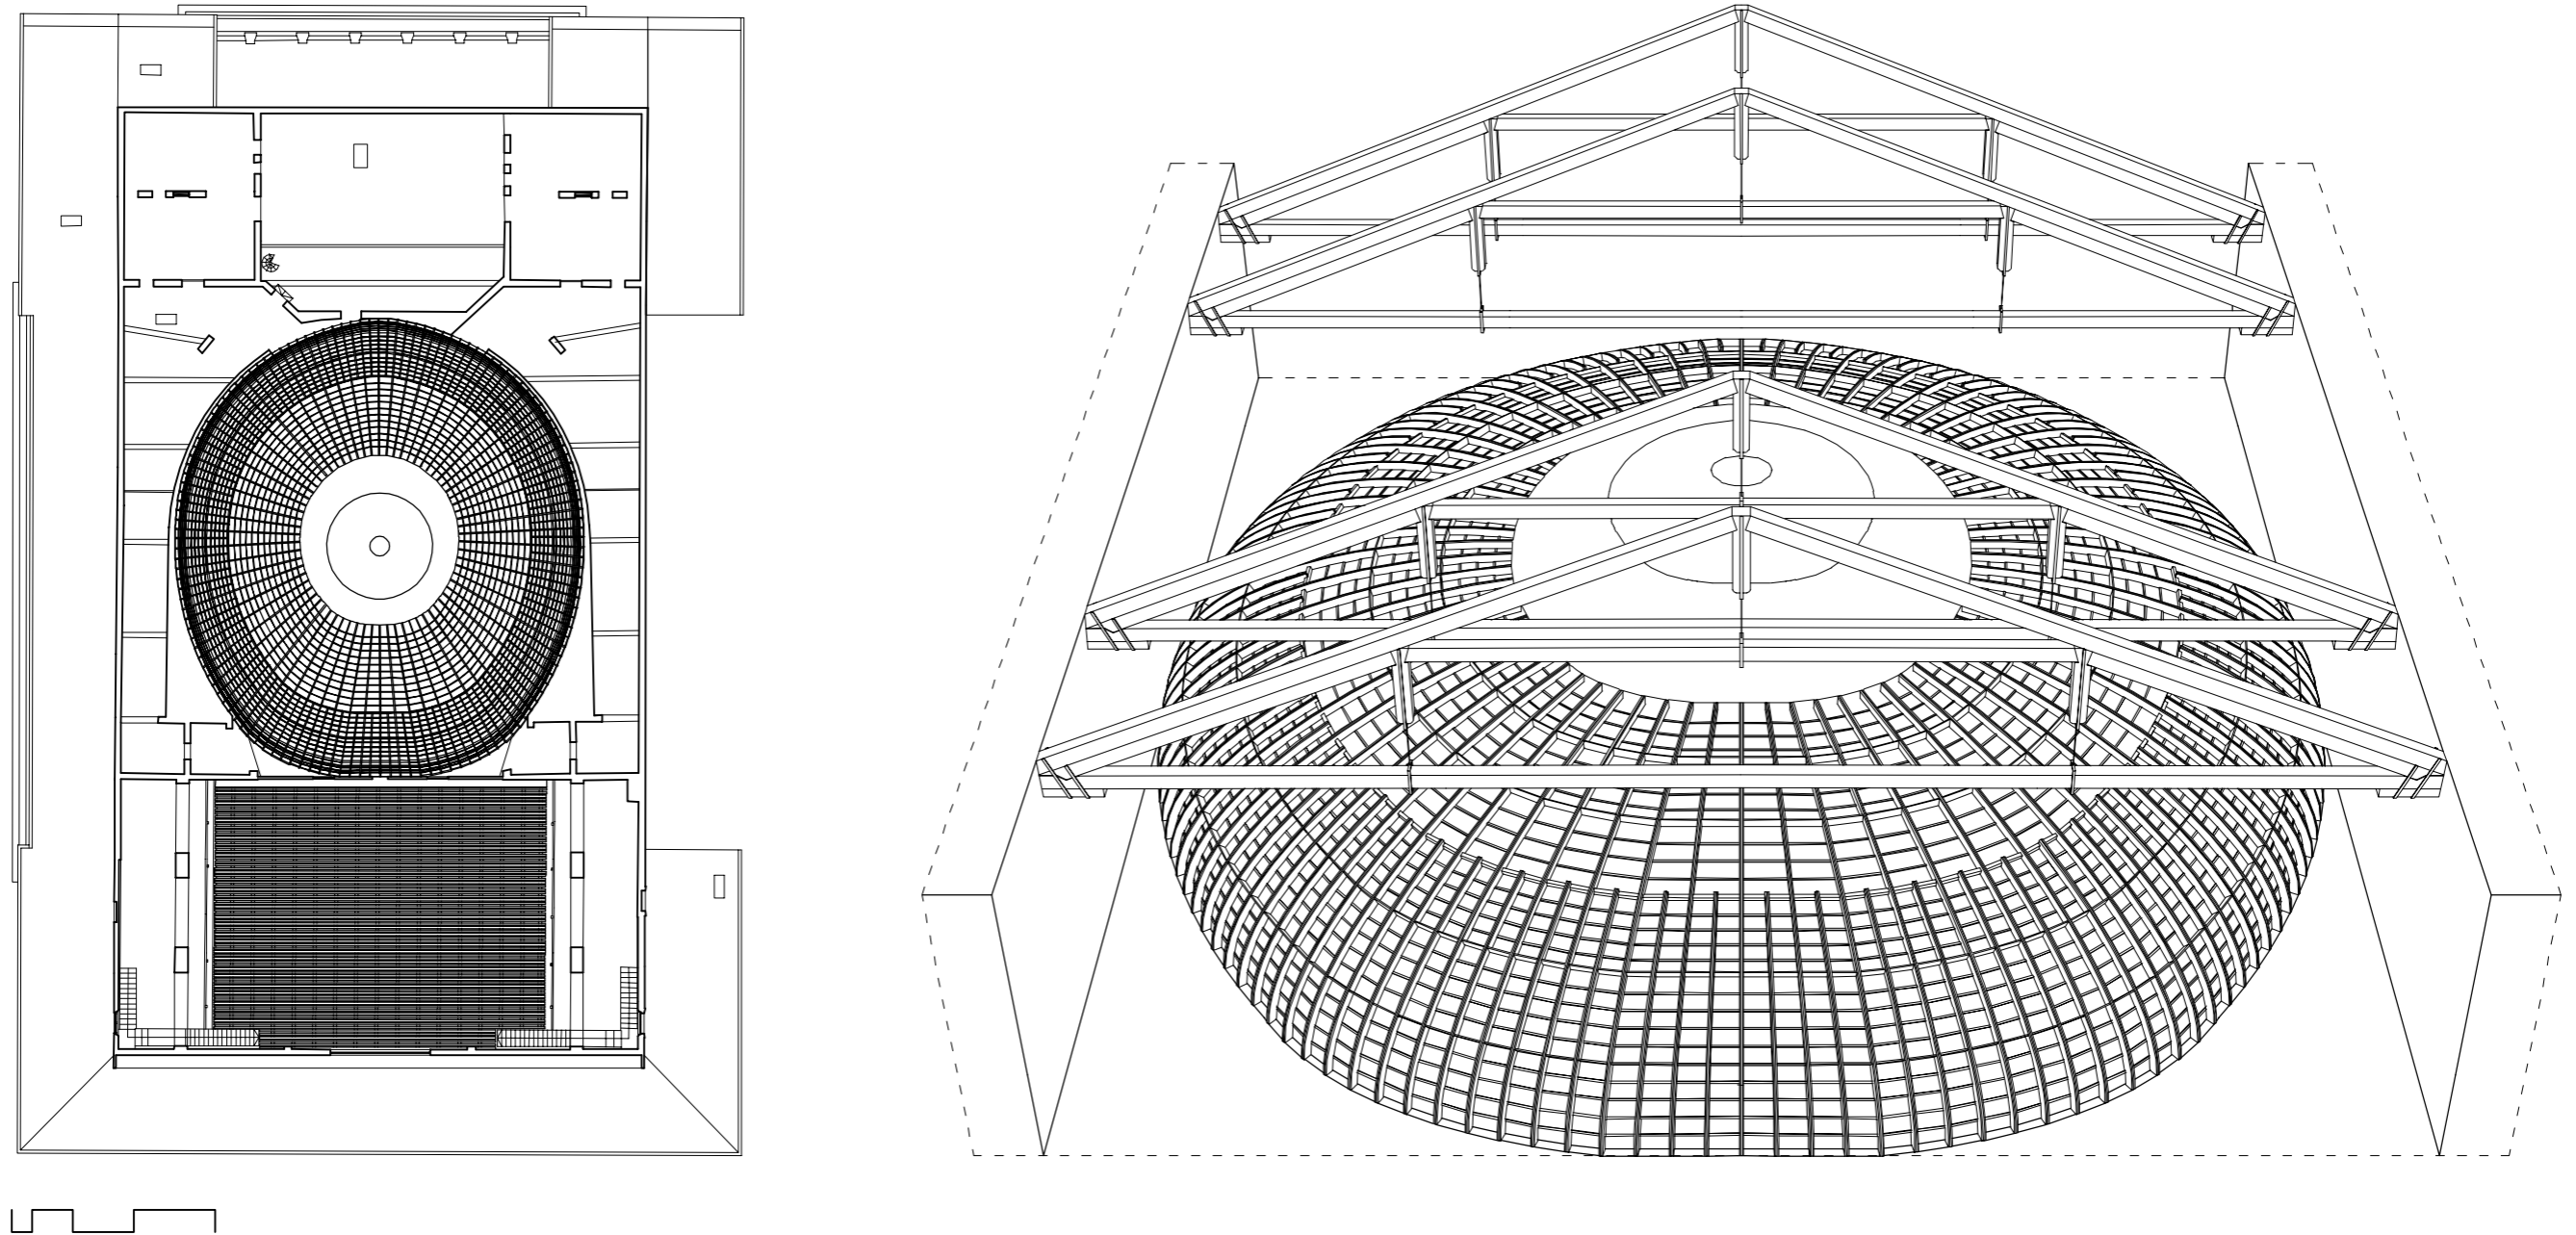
Teatro "Storchi" di Modena. Pianta del piano sottotetto (ridisegno); rappresentazione prospettica del sistema di copertura della sala.
